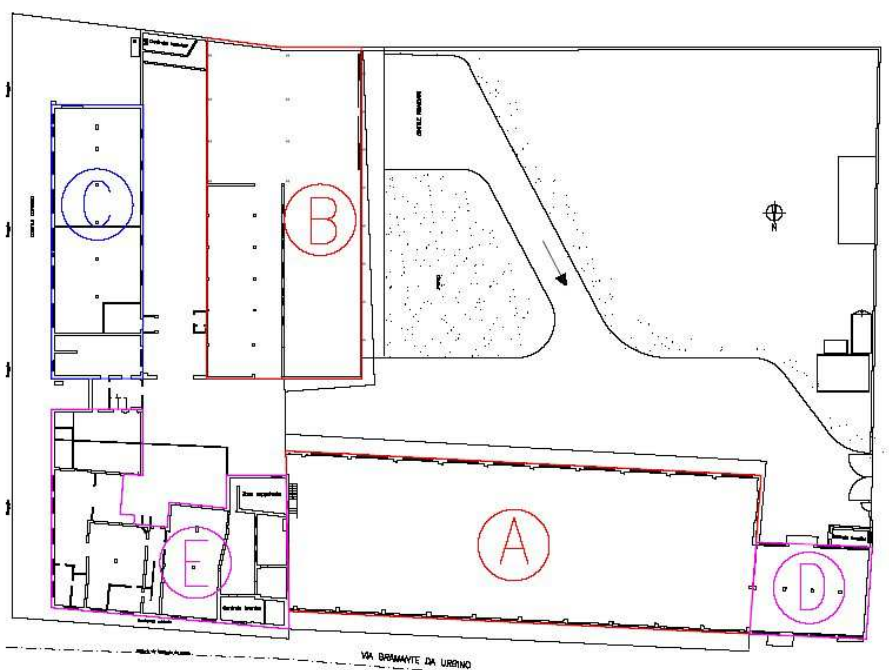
Stato di fatto – Piano Terra degli attuali corpi di fabbrica che saranno tutti oggetto di demolizione
